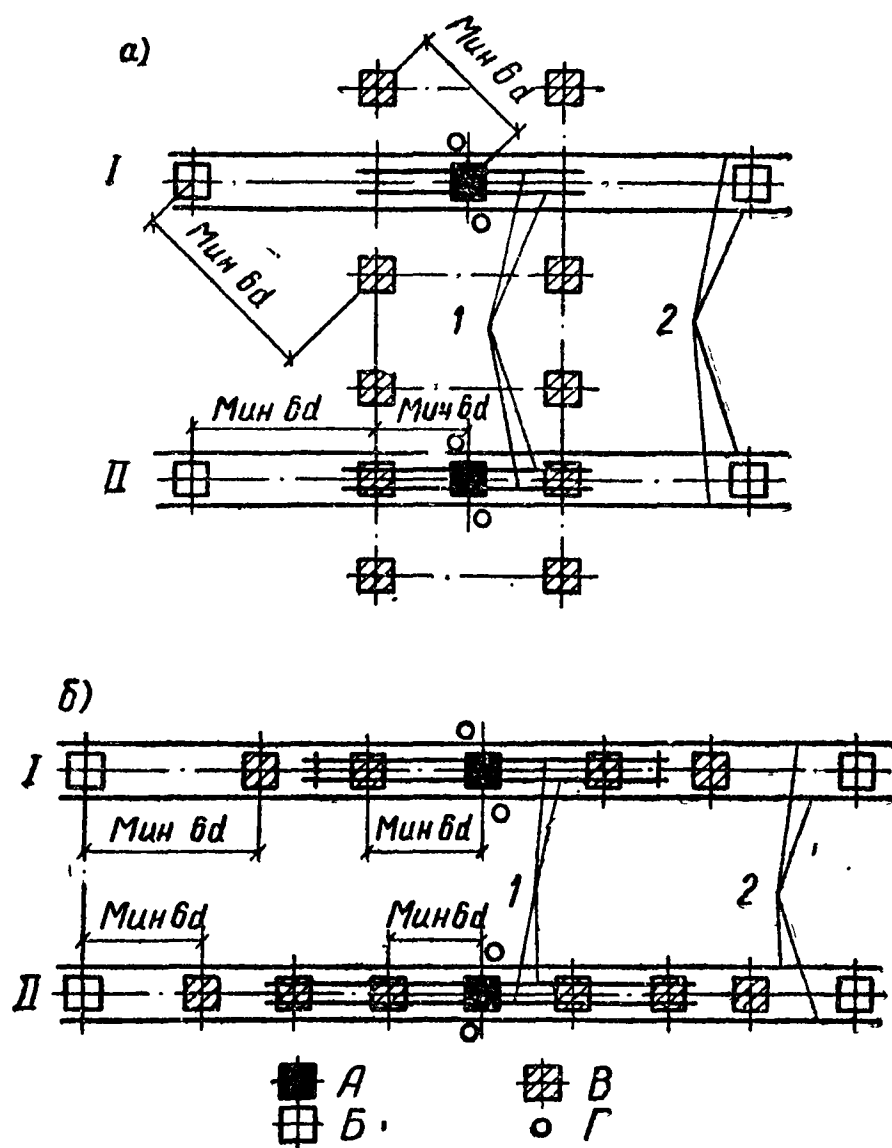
Схемы размещения опытных и анкерных свай при испытании статической нагрузкой
